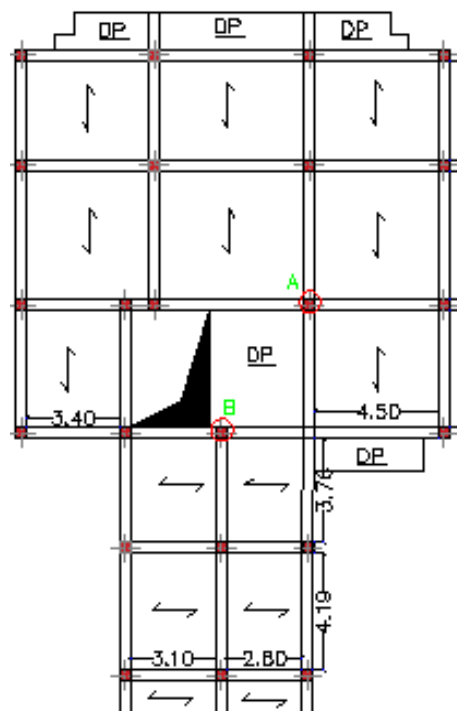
la disposition dalle de 1^{er} et 5^{eme} étage
